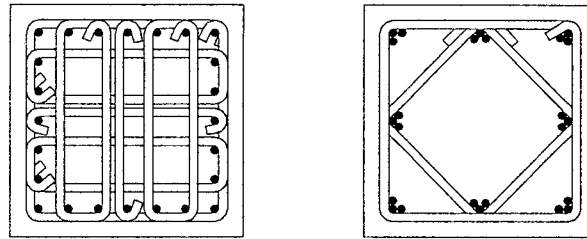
Refuerzo convencional en una columna y refuerzo con barras agrupadas en paquetes.
